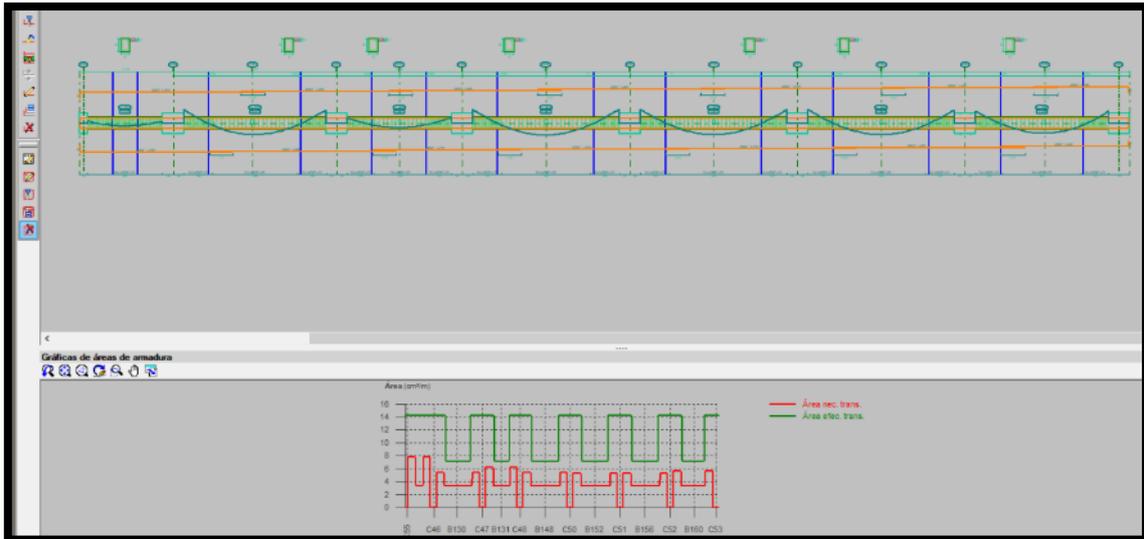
Despiece Vigas VITRO (CYPE Ingenieros, 2018)
